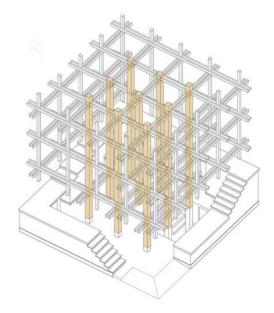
Técnica constructiva utilizada en el proyecto. Fuente: Nest We Grow / Kengo Kuma & Associates + College of Environmental Design UC Berkeley, 2014, (https://archdaily.com)
